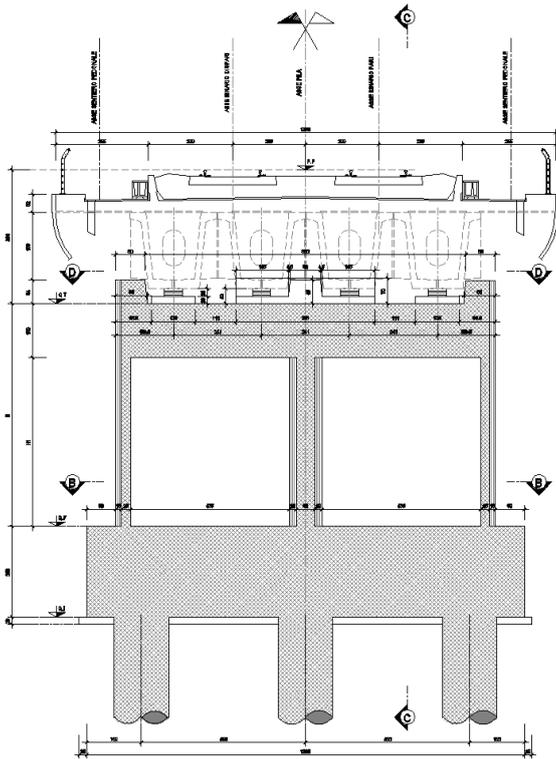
Sezione in direzione longitudinale e trasversale pila CAP
